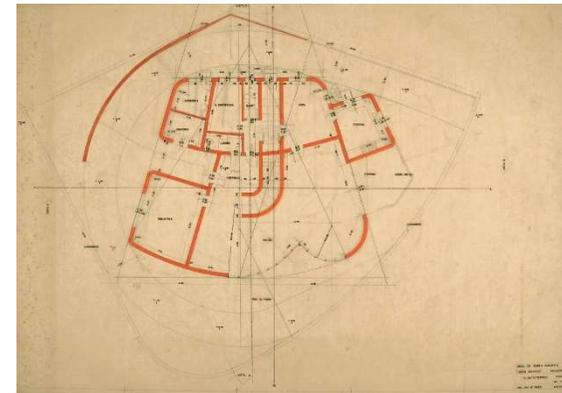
Planimetría: planta Casa do Chame Chame
